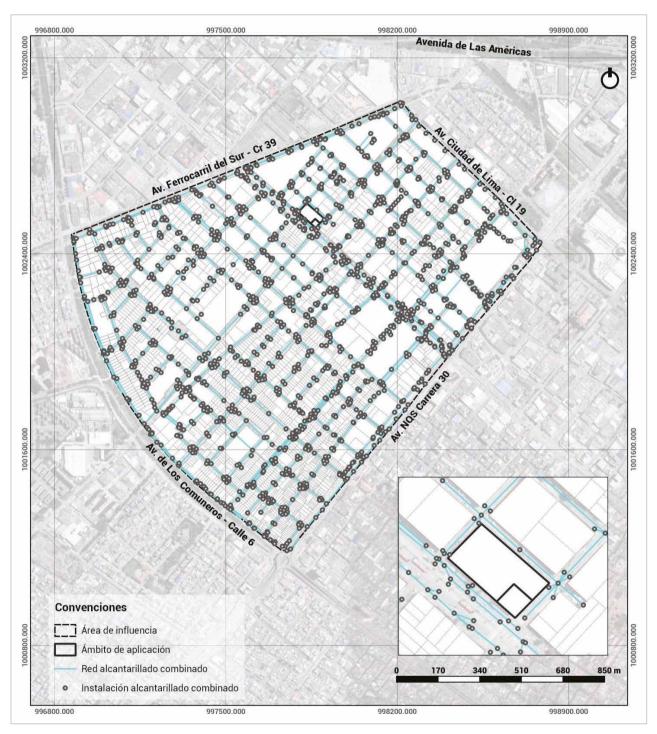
Plano de red de alcantarillado combinado Fuente: Elaboración propia
